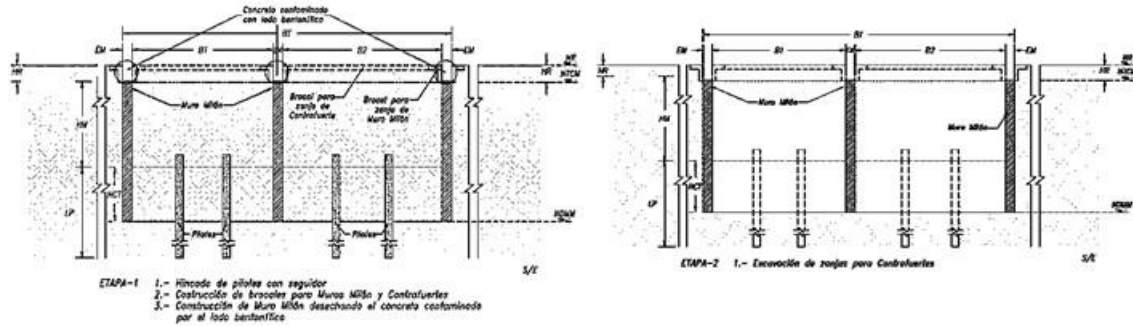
Procedimiento constructivo Túnel GSE de sección cerrada etapa 1 y 2 (Plano constructivo BT 86 CRS XXXTE 211).
